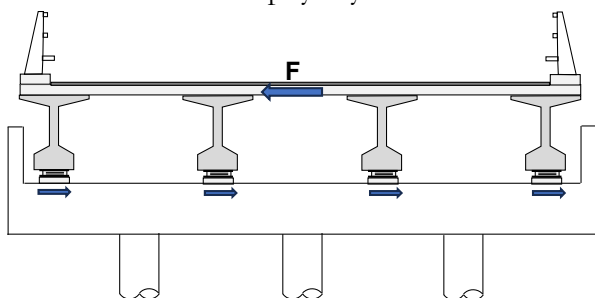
Transferencia de cargas desde la losa superior hasta los apoyos.
